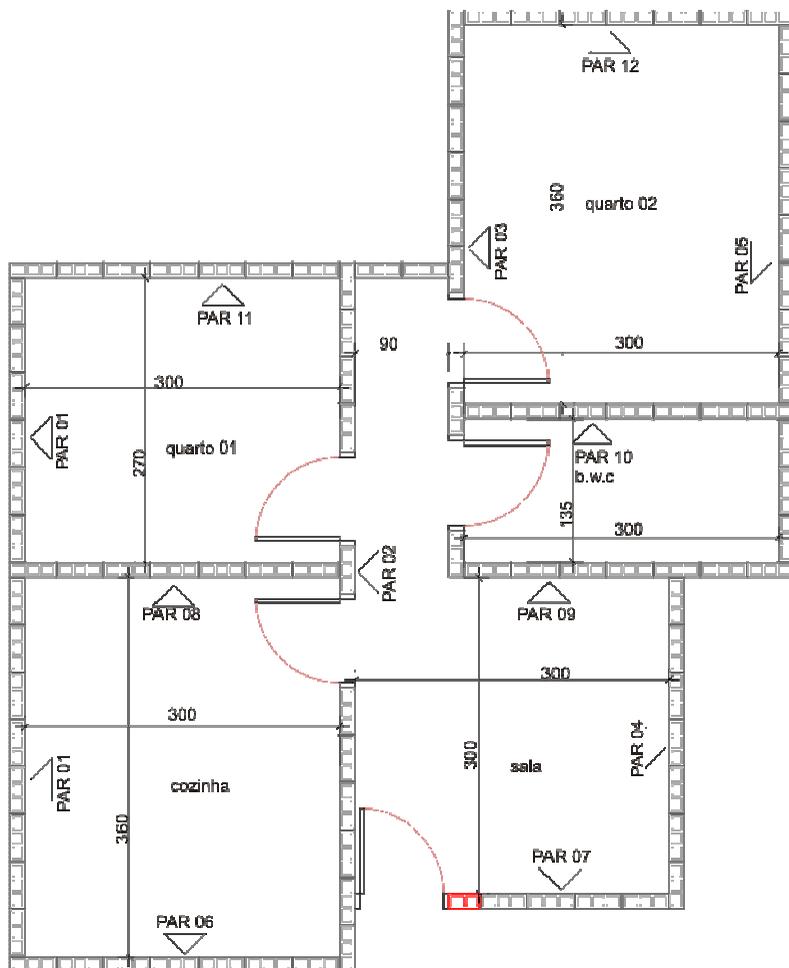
Planta Baixa de modulação da primeira fiada para a Modulação 04
